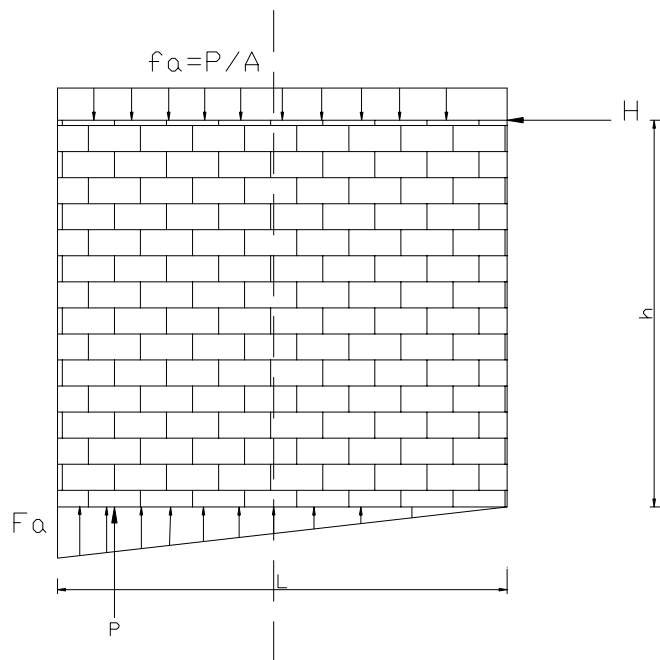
Equilibrio de la mampostería no reforzada en el instante de tracción nula
